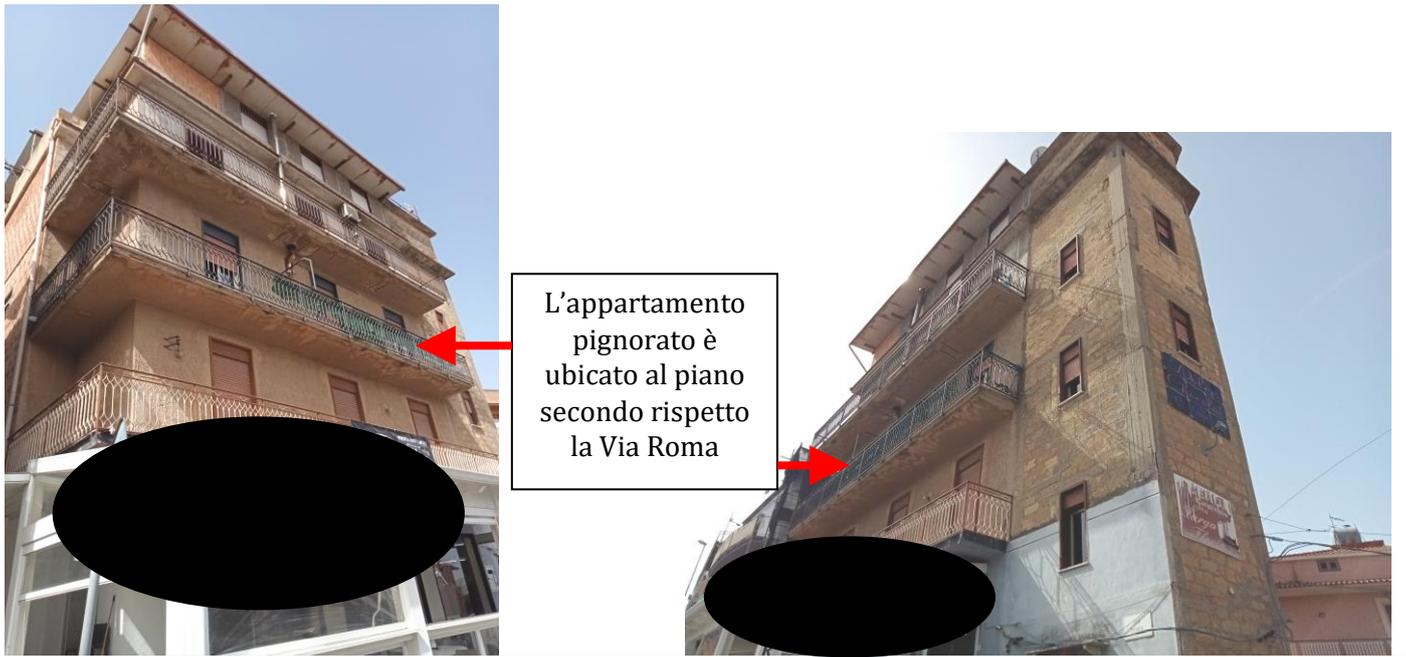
, 2: "Prospetto principale intero fabbricato della Via Roma"
